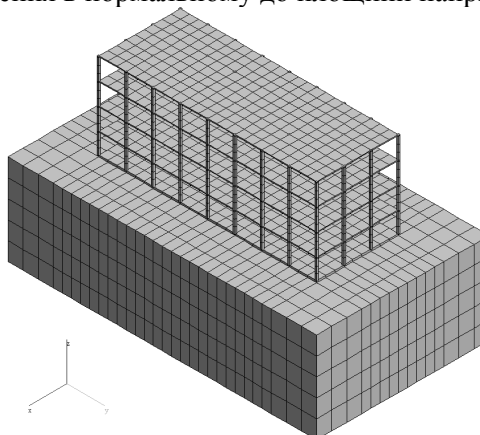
Скінченно-елементна модель промислової будівлі як системи «основа – фундамент – будівля»
